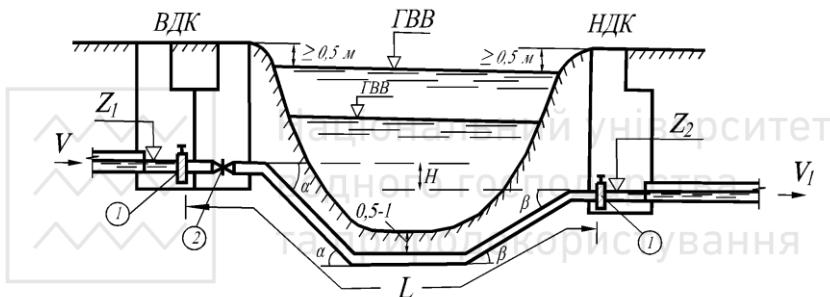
Розріз та план дюкеру: 1 –заслінка (шибер) у вхідній (ВДК) та вихідній (НДК) камері дюкеру, 2 –засувка у вхідній камері дюкеру.
